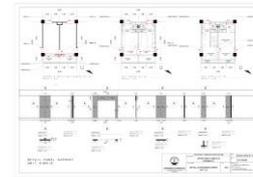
Detail Perubahan Lantai Unit Apartemen Hibrid
